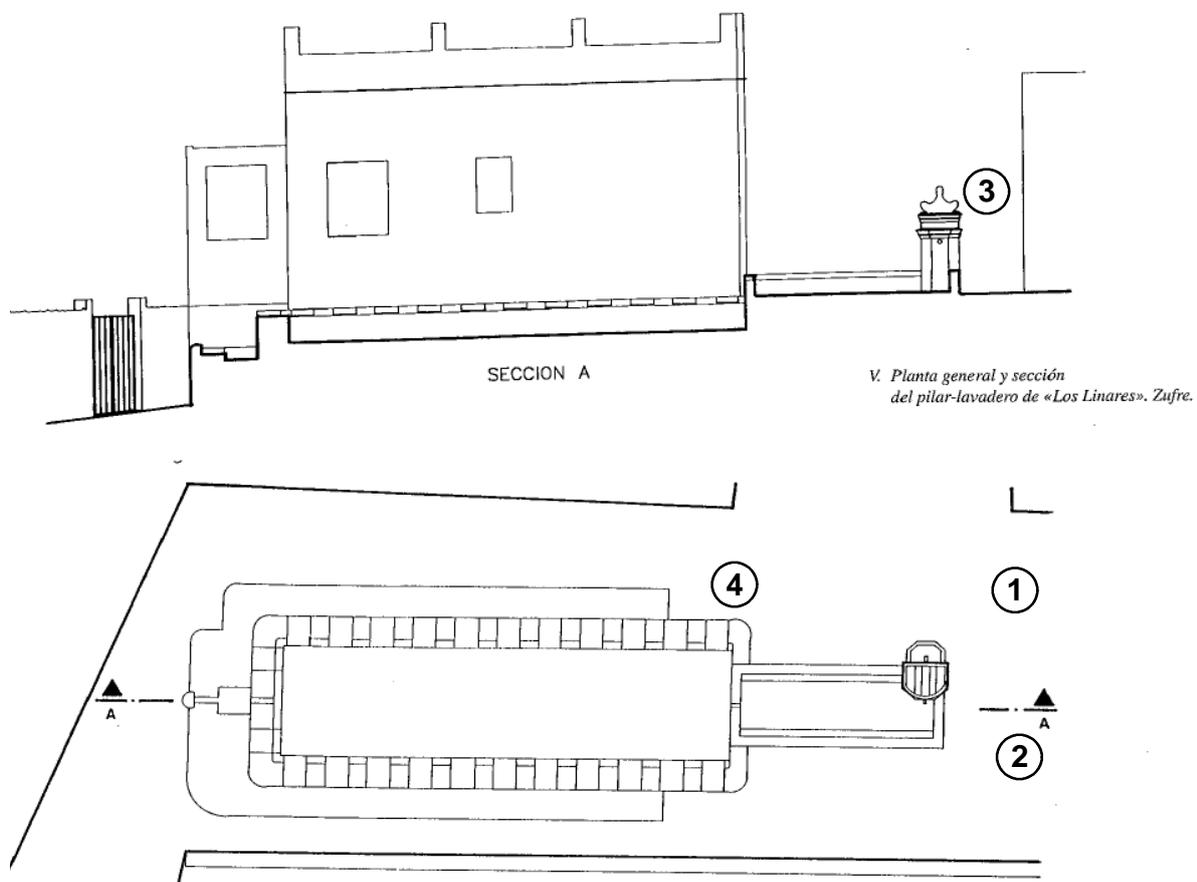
Planta general y sección del pilar-lavadero de Los Linares (Zufre) (Medianero, 2003)
